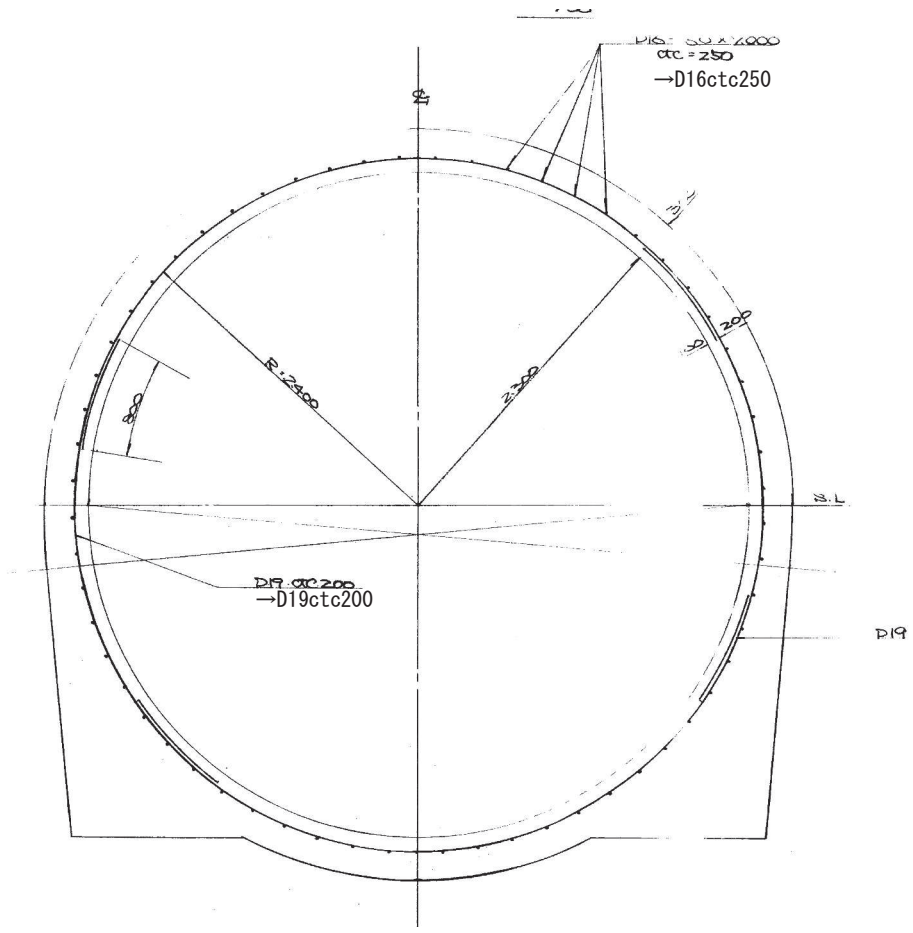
(3) 取放水路流路縮小工 (第 1 号機放水路) の構造概要図
